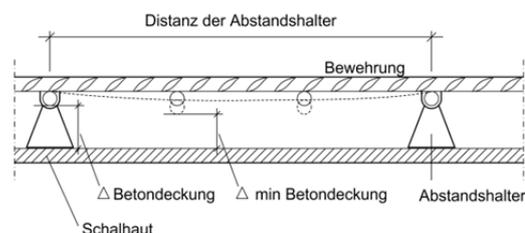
Abstandhalter und minimale Betonüberdeckung
